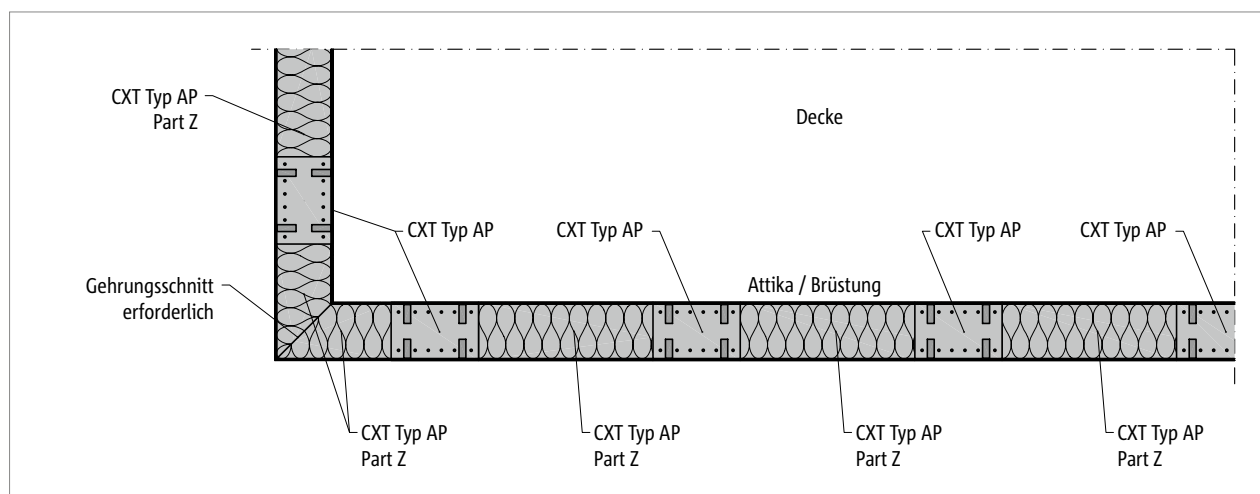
Schöck Isokorb® CXT Typ AP: Gehungsschnitt Schöck Isokorb® CXT Typ AP Part Z bei Bauteilecken
